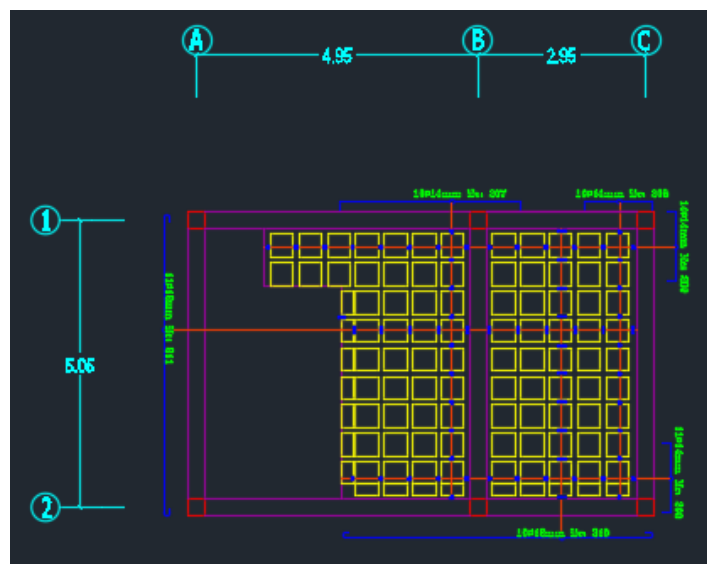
Losa Tipo 2 Planta N 0+7.54
